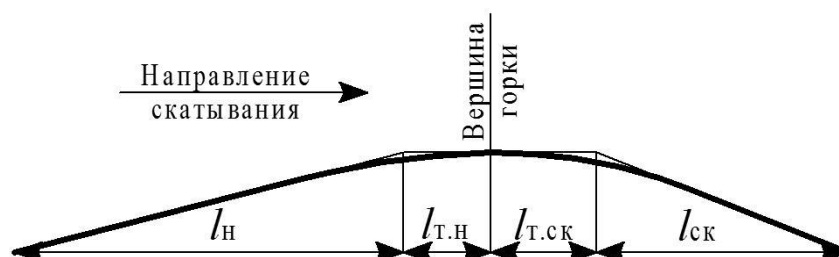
Схема разбивки вершины сортировочной горки на элементы
